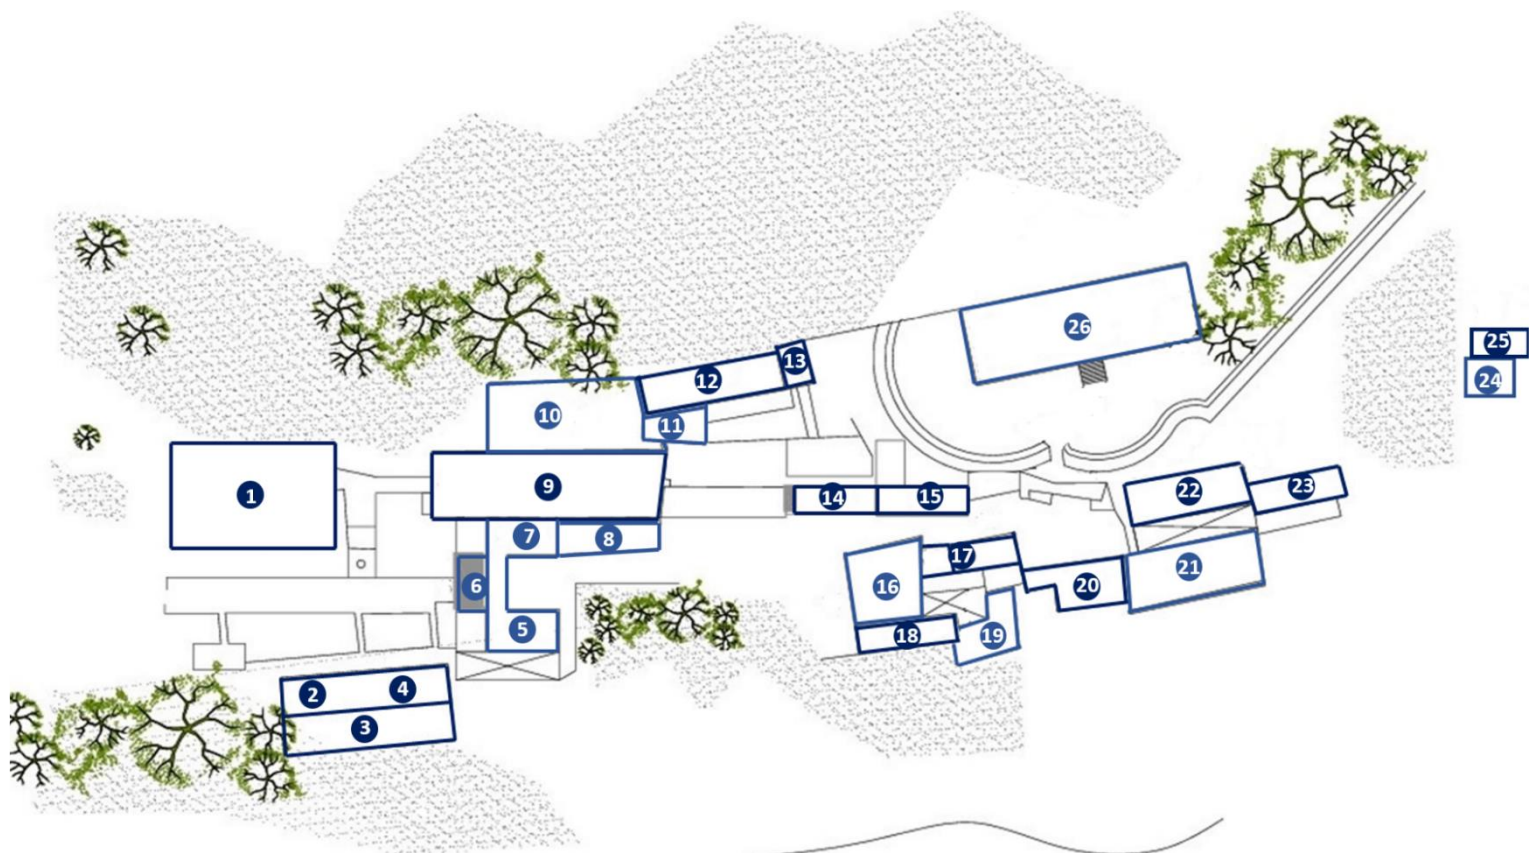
Planta del conjunto de la Ex Hacienda "Molino de las Flores" 1. Machero | 2. Tienda de raya | 3. Caballeriza | 4. Panadería | 5. Cochera | 6. Pórtico | 7. Portero | 8. 6Talabartero | 9. Tinacal | 10. Ranchería | 11. Herrería | 12. Troje no.1 | 13. Casa de servicios | 14. Colegio | 15. Casa de visitas | 16. Monturas | 17. Capilla de San Joaquín | 18. Curato | 19. Troje no.2 | 20. Casa principal | 21. Molino | 22. Molino (turbinas) | 23. Batán | 24. Capilla del Señor de la Presa | 25. Panteón familiar | 26. Troje no.3
